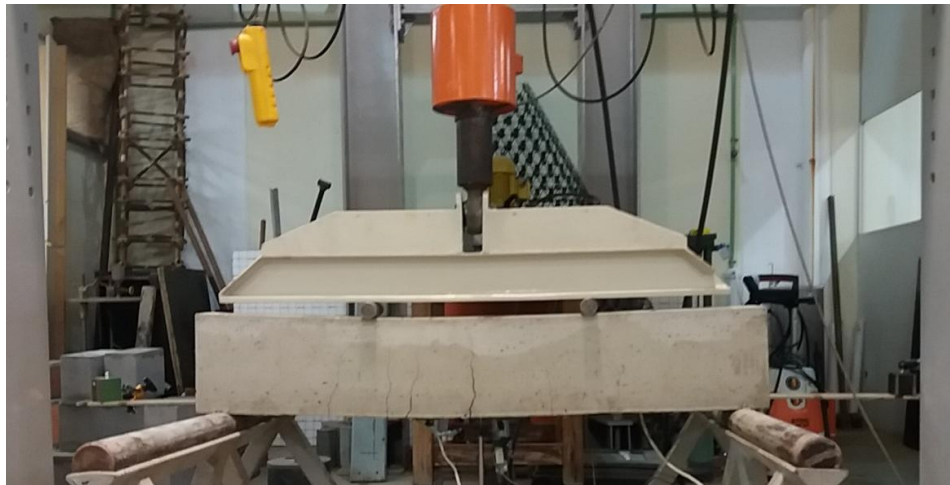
TREF CE – detalhes fissuras
